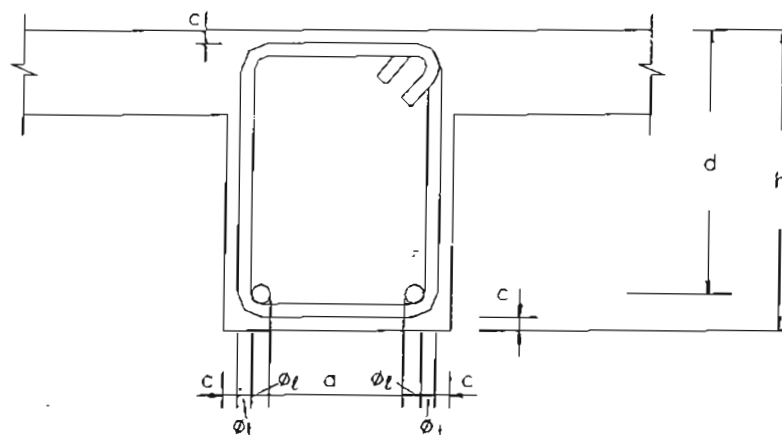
Espaçamento mínimo das barras longitudinais
